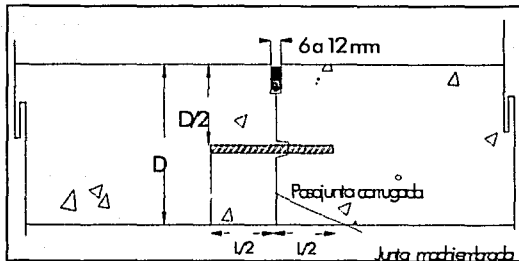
Junta longitudinal de construcción con pasajunta corrugada y machimbre.
